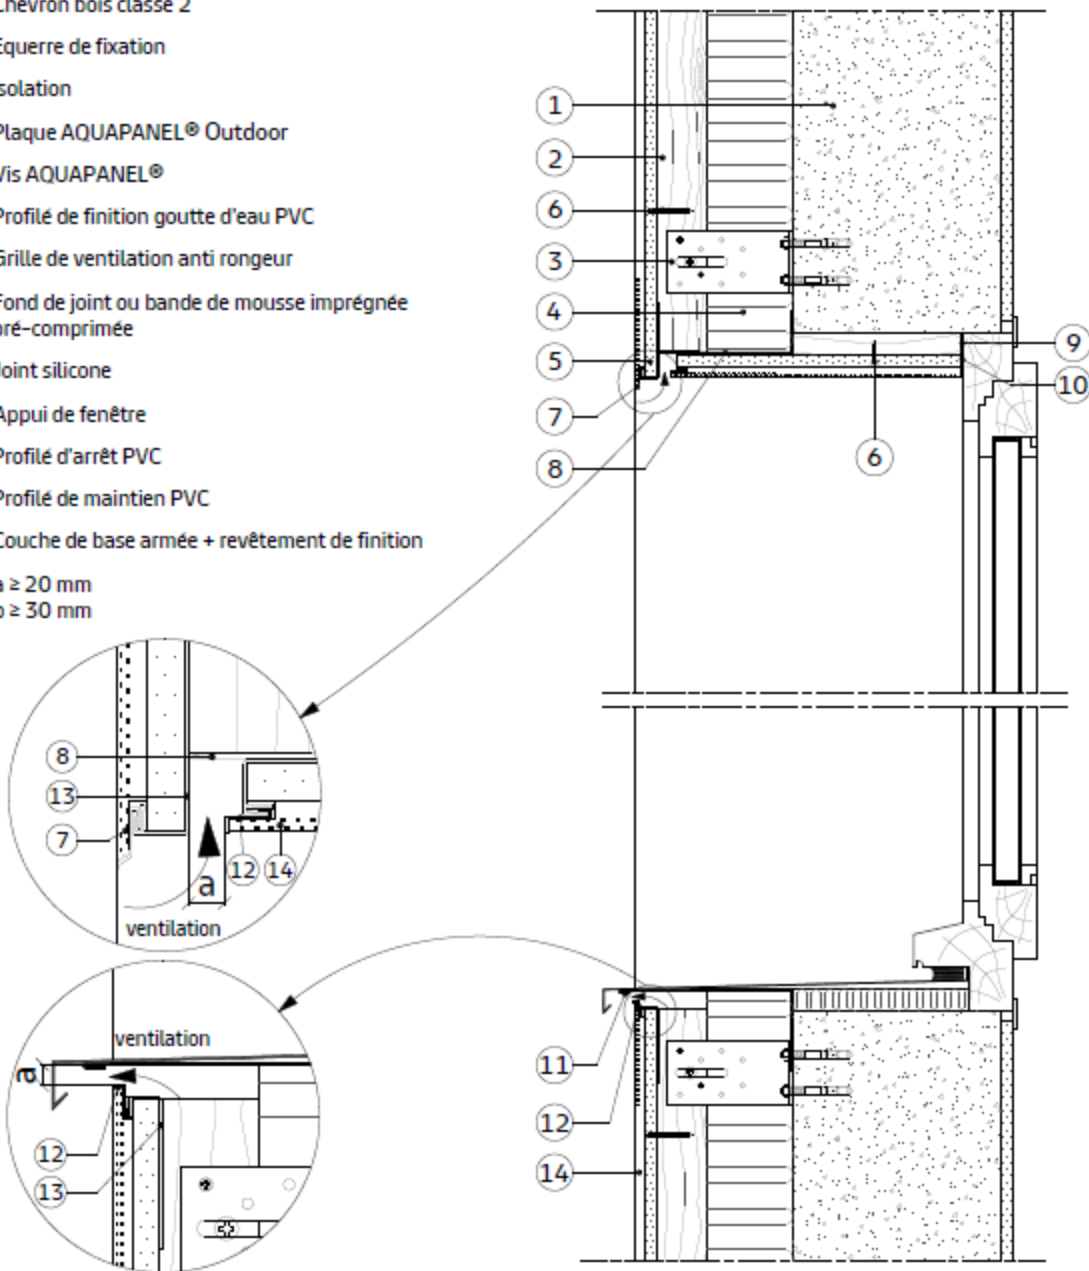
Traitement en linteau et en appui de fenêtre - Coupe verticale sur ossature bois
